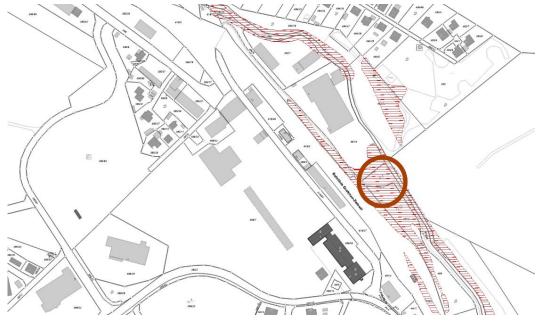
Lageplan mit eingetragenen Biotop und umrandeten Baugrundstück
